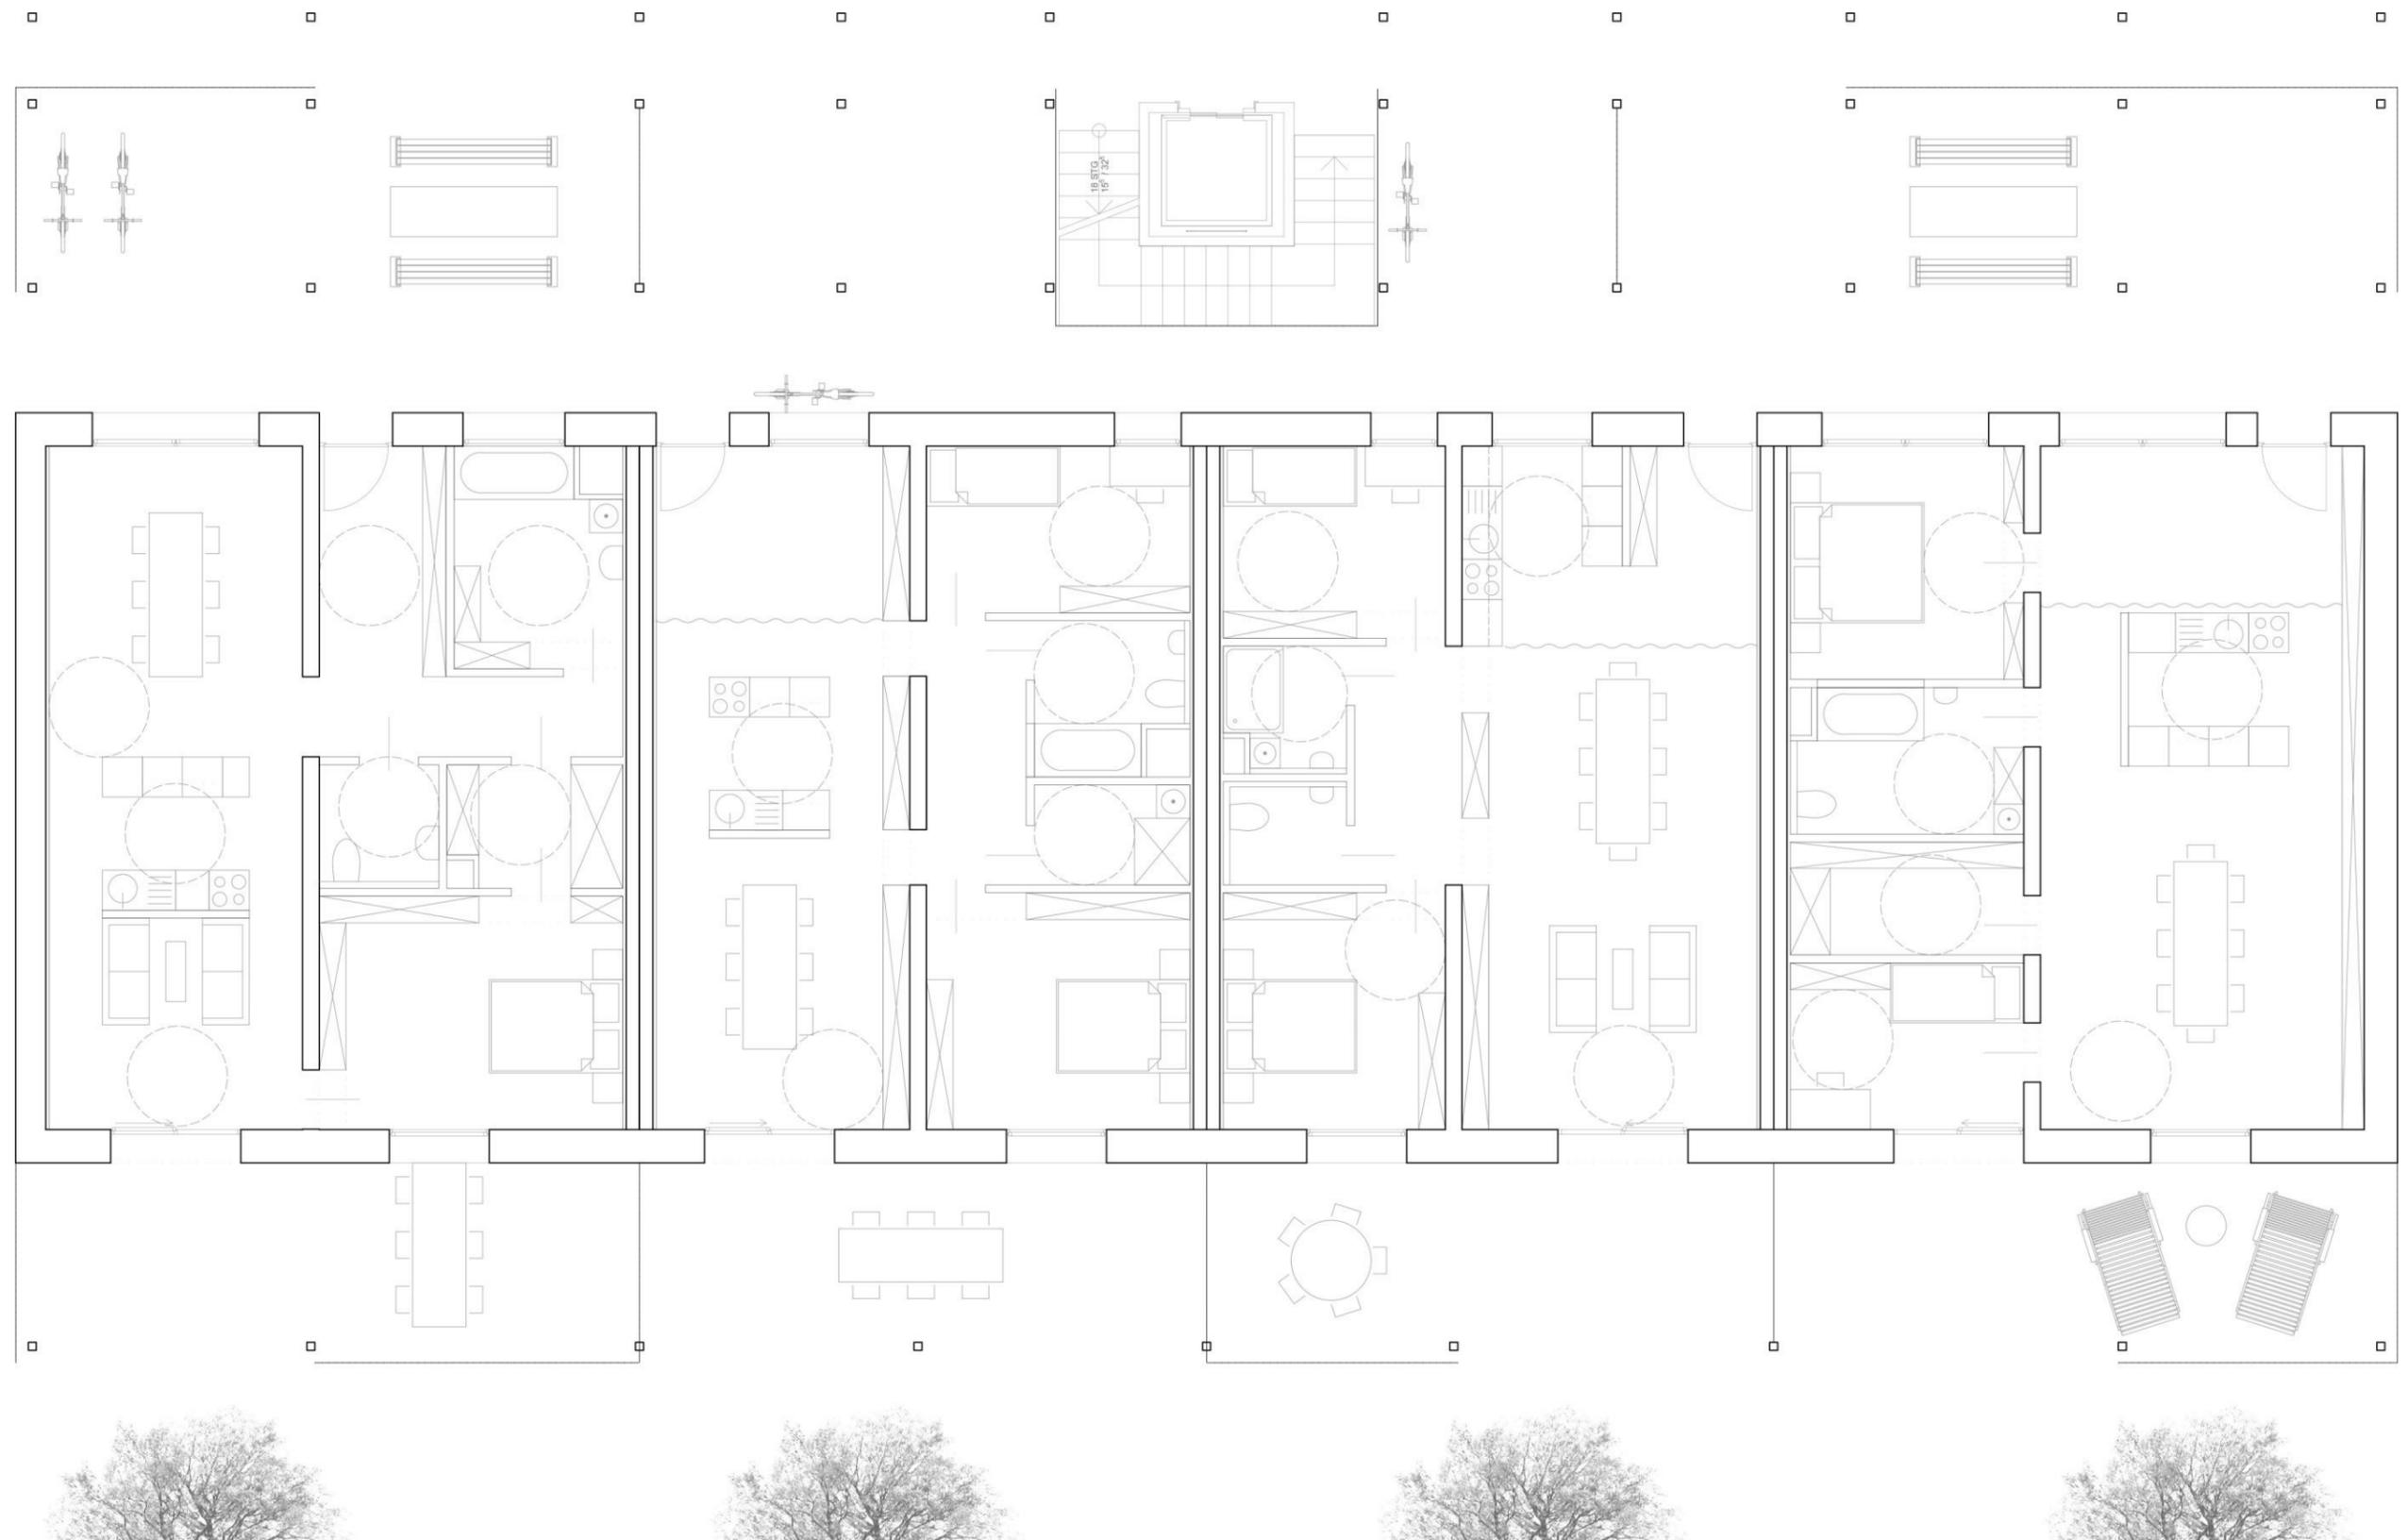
Grundriss Erdgeschoss M1:100
